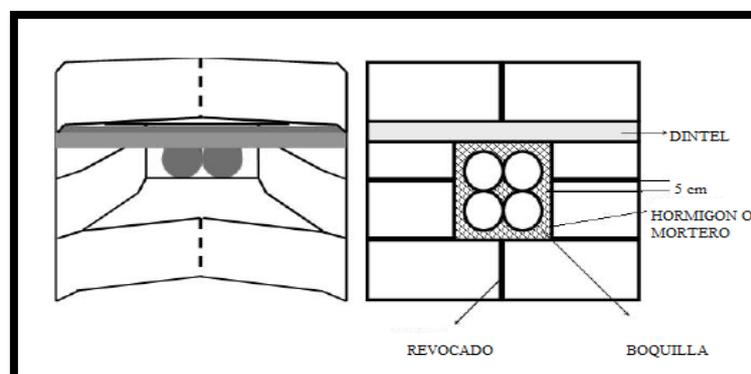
Acceso al pozo con elementos de boquilla y dintel
